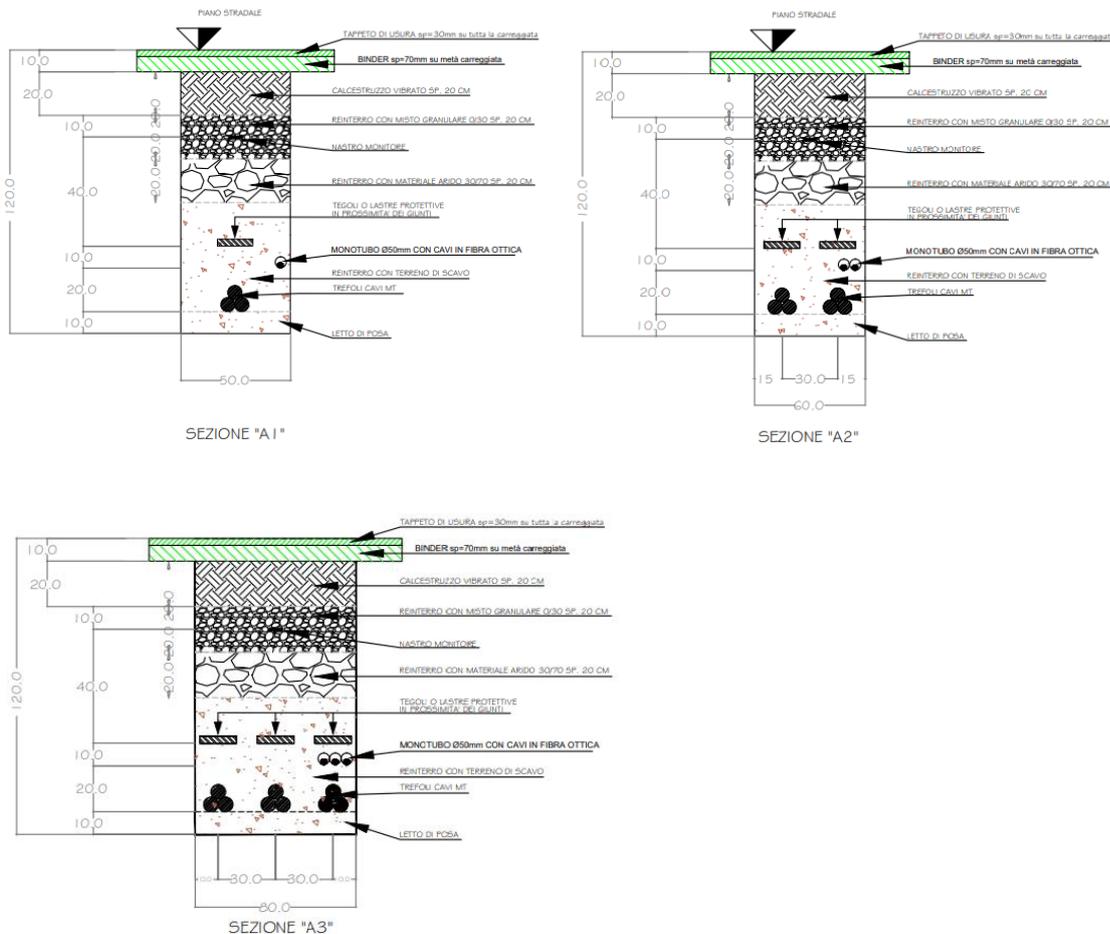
Sezioni di posa cavi MT su strade asfaltate
